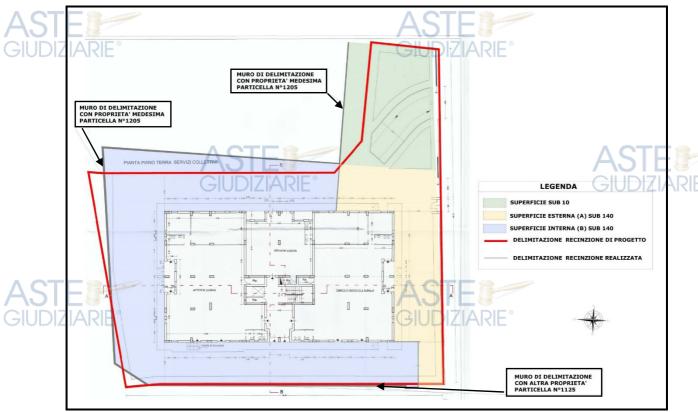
Sovrapposizione grafica della planimetria al piano terra fra progetto assentito con lo stato dei luoghi
